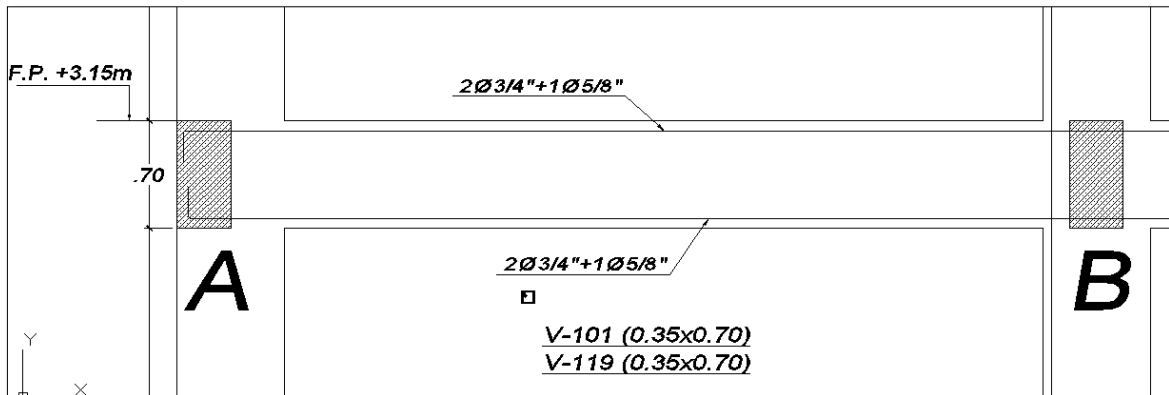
Detalle de Acero longitudinal en el tramo de viga A-B del nivel +3.15
